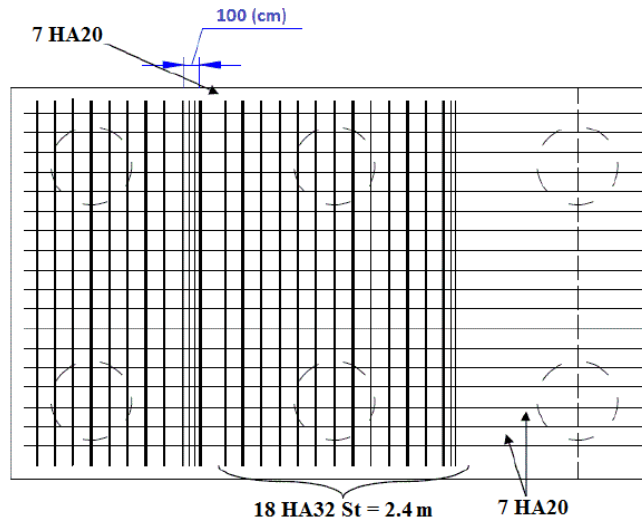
Ferrailage de la semelle (nappe inférieure).
